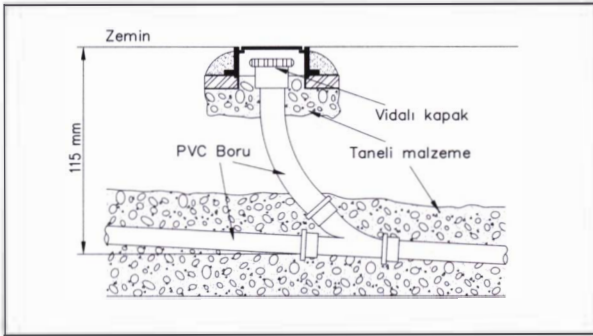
KURU RÖGARLI SİSTEM PLANI
